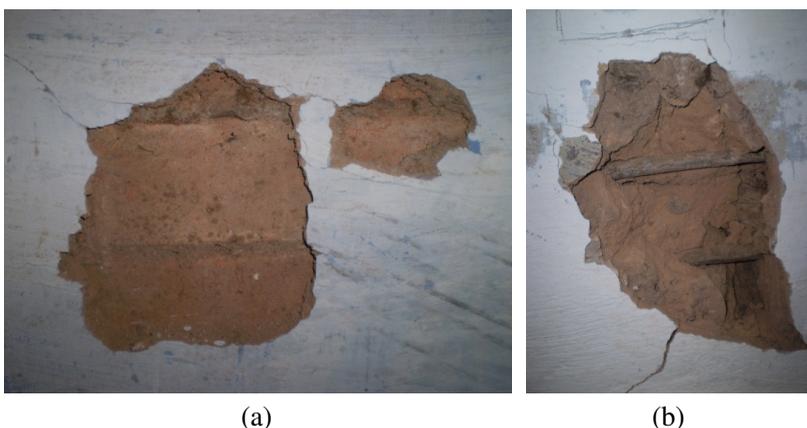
(a) Prospecção em parede de tijolo maciço; (b) Prospecção em parede de pau-a-pique onde já havia trinca
